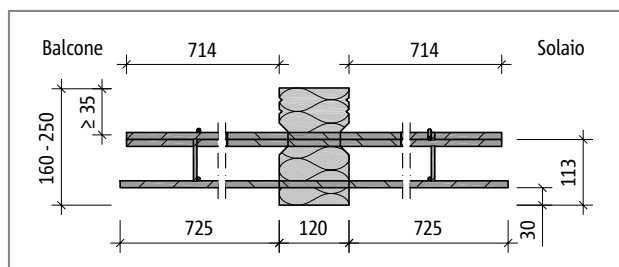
Schöck Isokorb® tipo EQXT2: sezione dell'elemento
